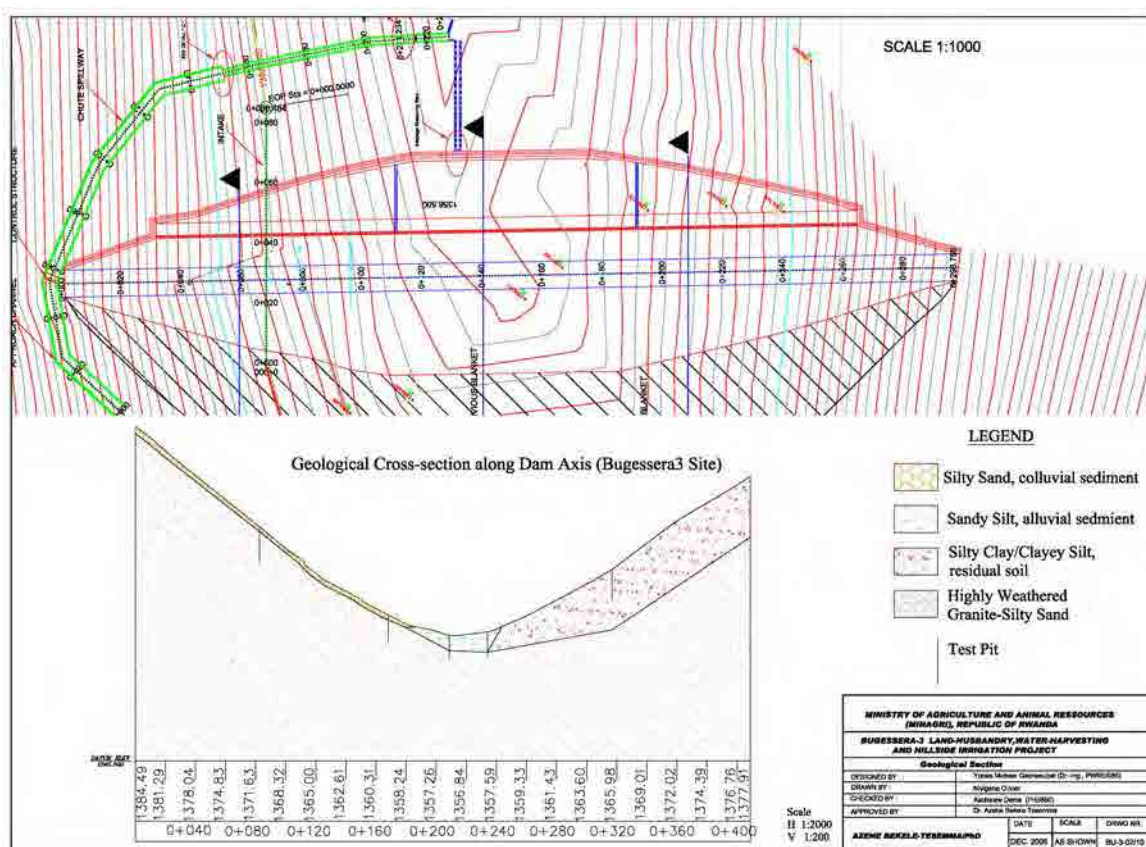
ダム軸平面縦断面図 (LWH 報告書より)
